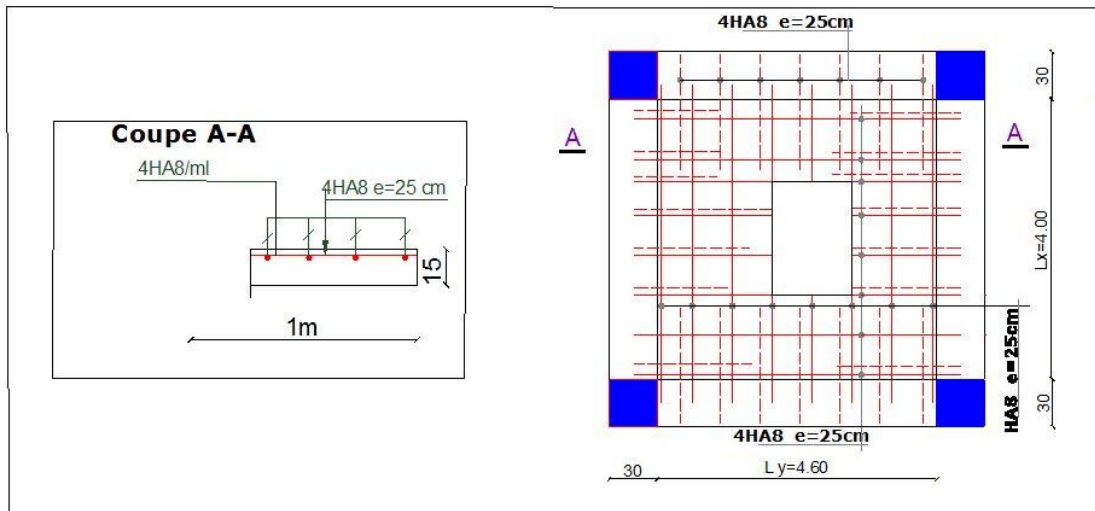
Schéma de ferrailage de la dalle d'ascenseur.
